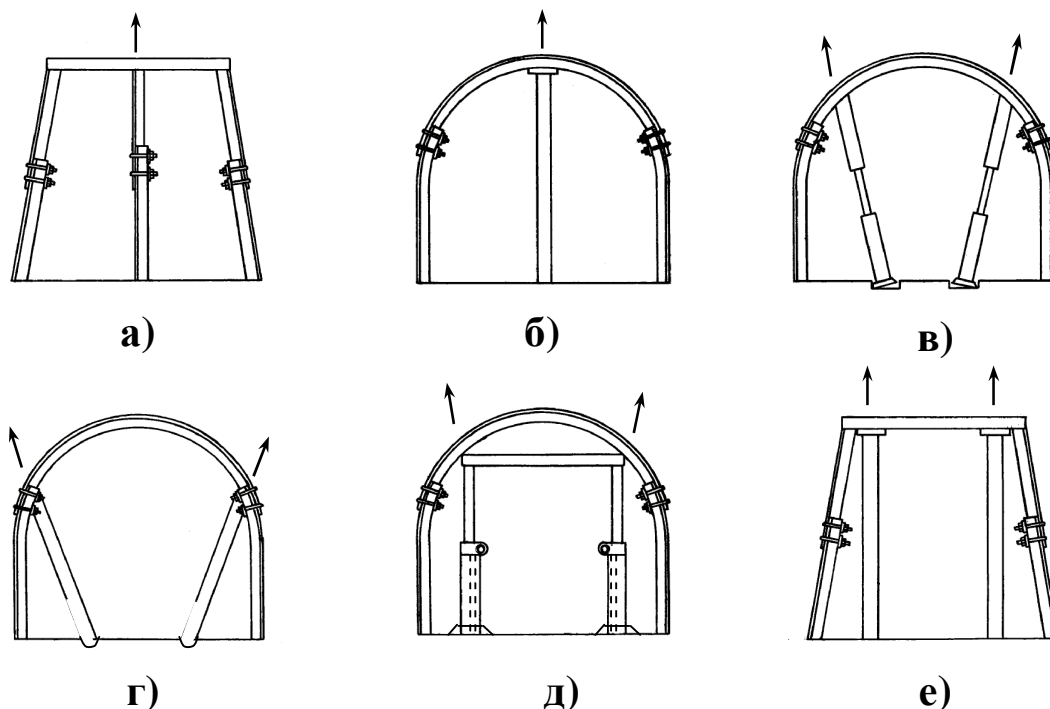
Основные схемы установки ремонтин в выработках: а – одна по центру выработки из стойки КМП–Т (П); б – тоже деревянная под верхняк КМП–А3; в – две косоустановленные ремонтинны из гидравлических стоек; г – тоже из деревянных стоек под замковые соединения; д – рамная установка ремонтин из стоек трения; е – две деревянные стойки под замковые соединения крепи КМП–Т (П)
